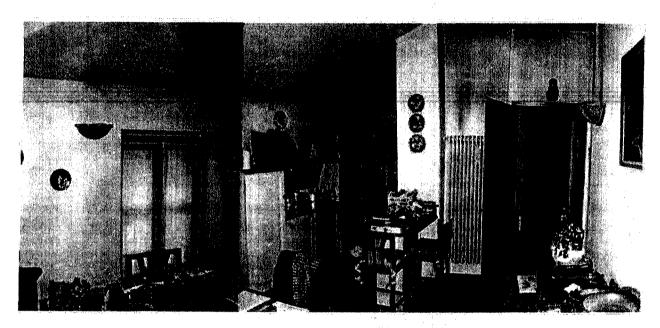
Rilievo interno – panoramica del locale cucina/pranzo/cottura.
